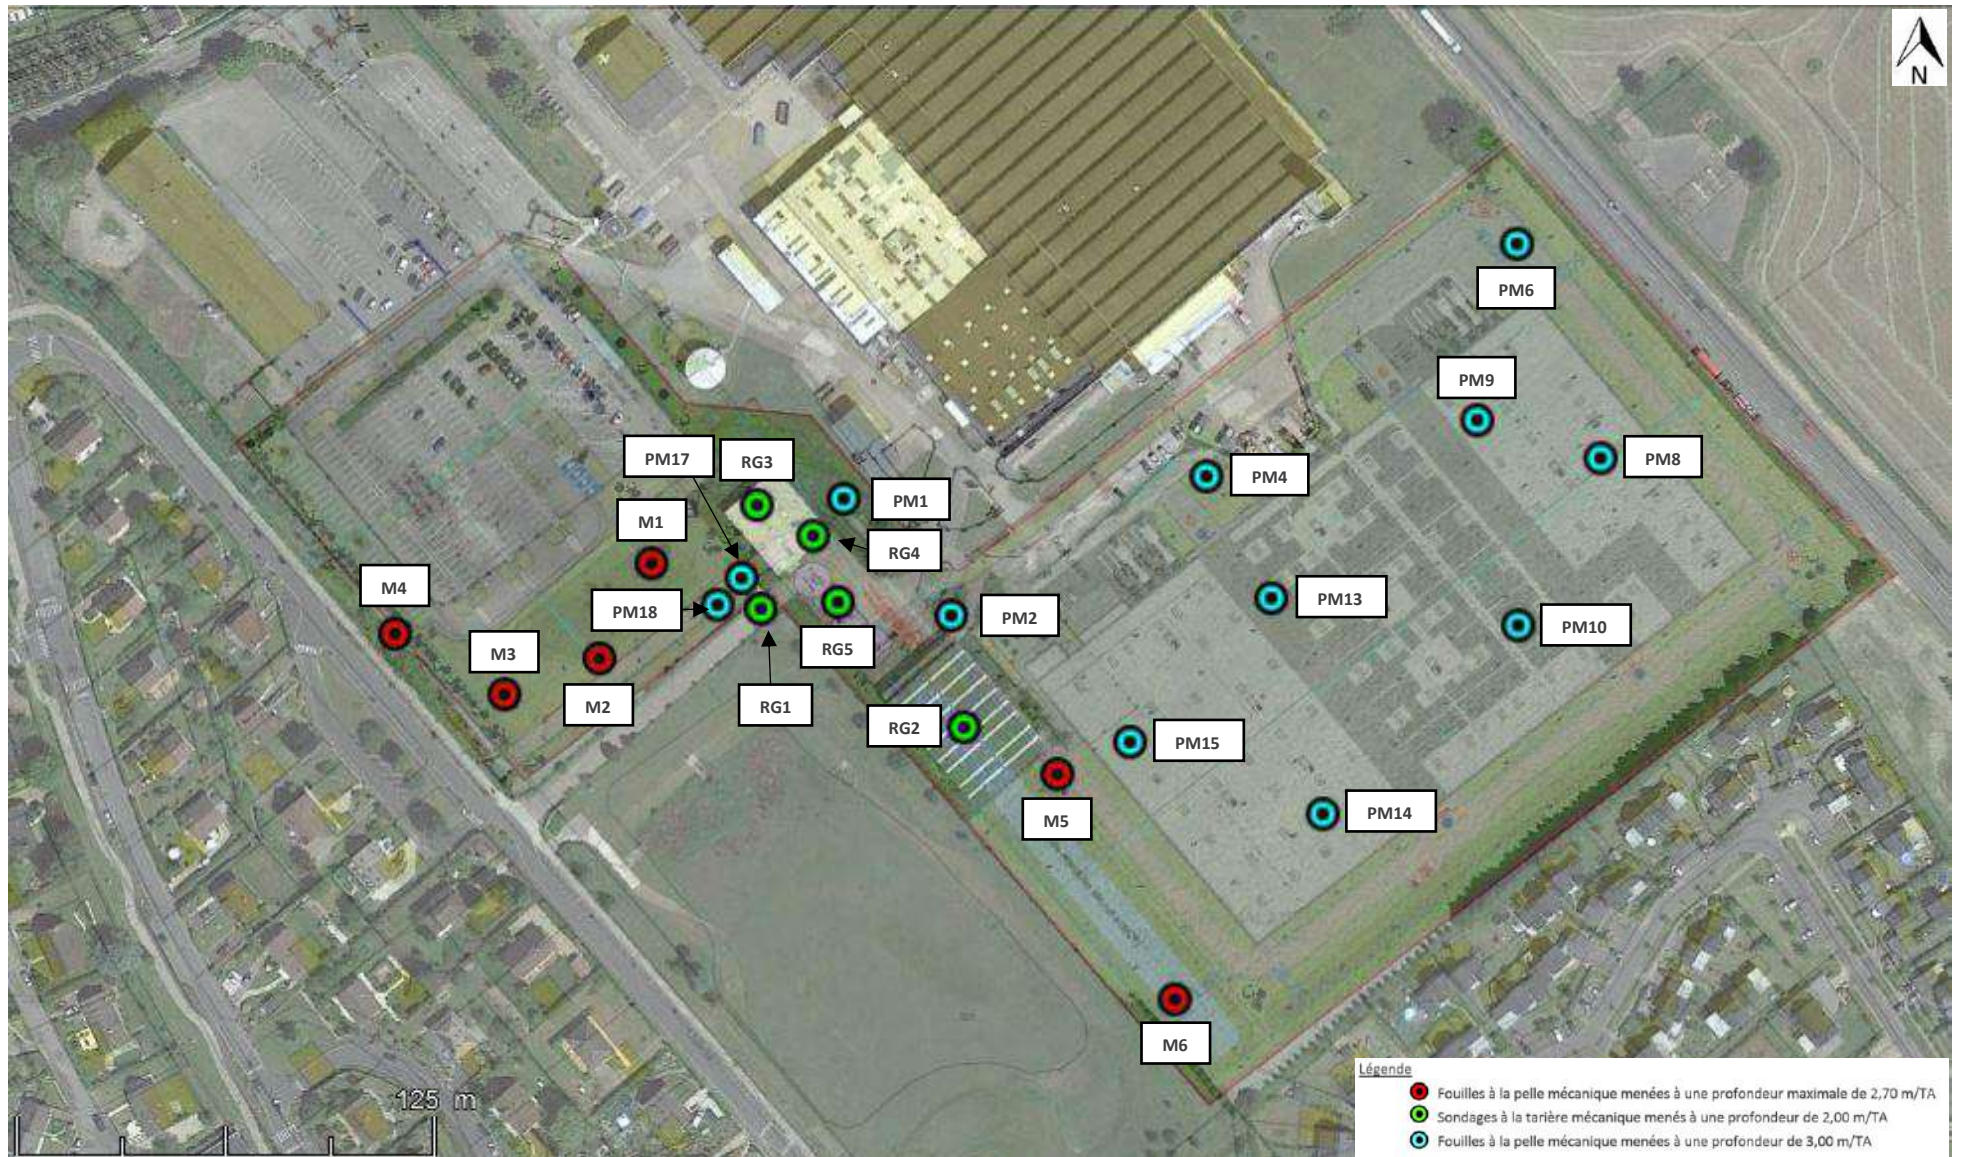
Plan de localisation des sondages sur le plan projet – étude GÉAUPOLE
